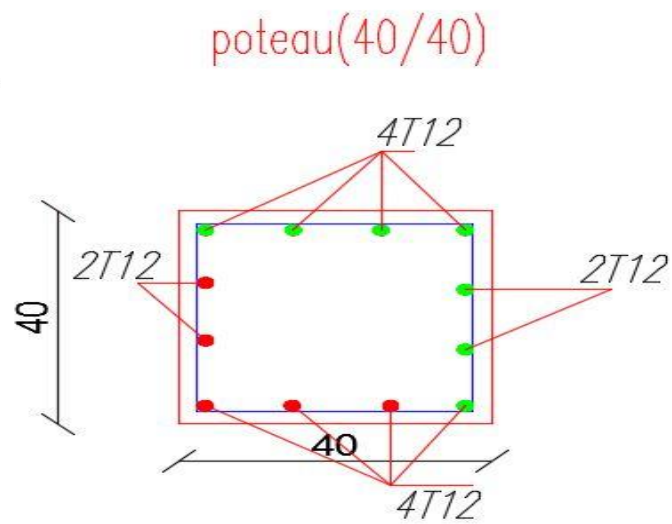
Coupe de ferrailage des poteaux 40×40 cm²
